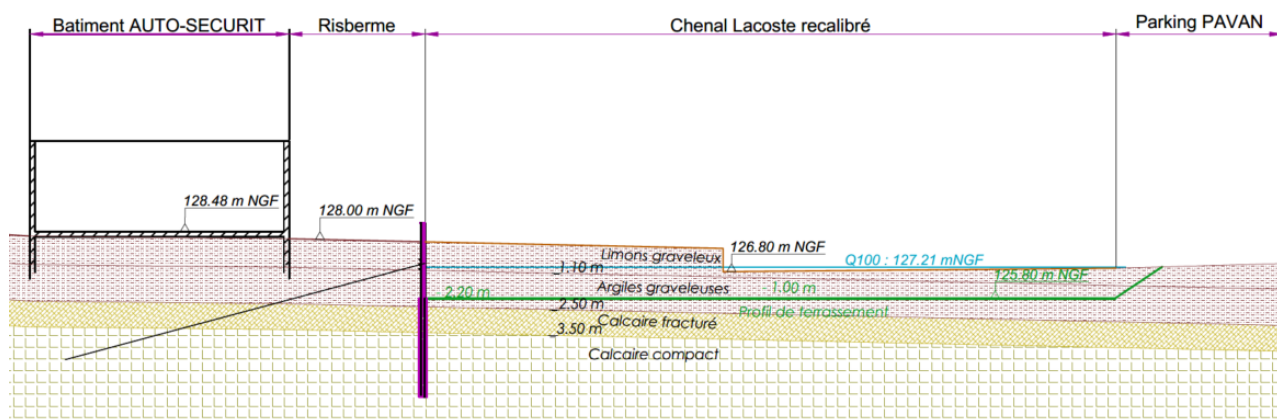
Coupe type de terrassement – Secteur amont PAVAN
